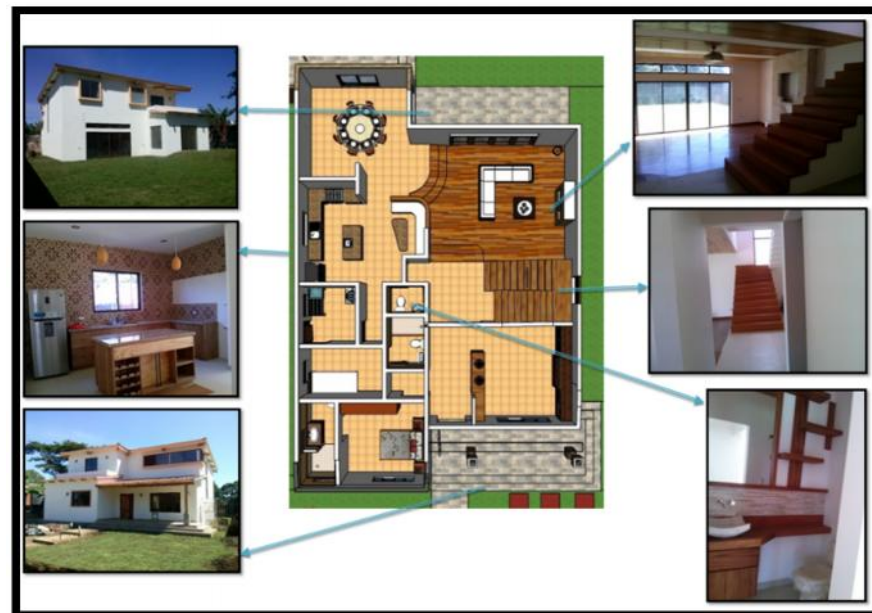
Acabados finales Planta Baja La Sebastiana
